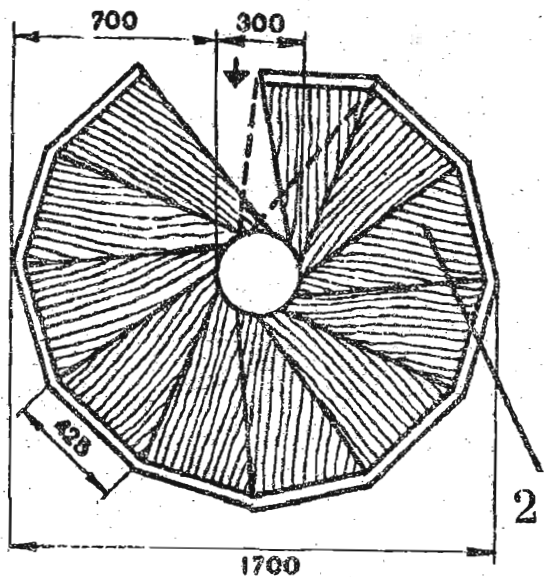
Размеры ступеней винтовой лестницы и их правильное закрепление (вид сверху).
